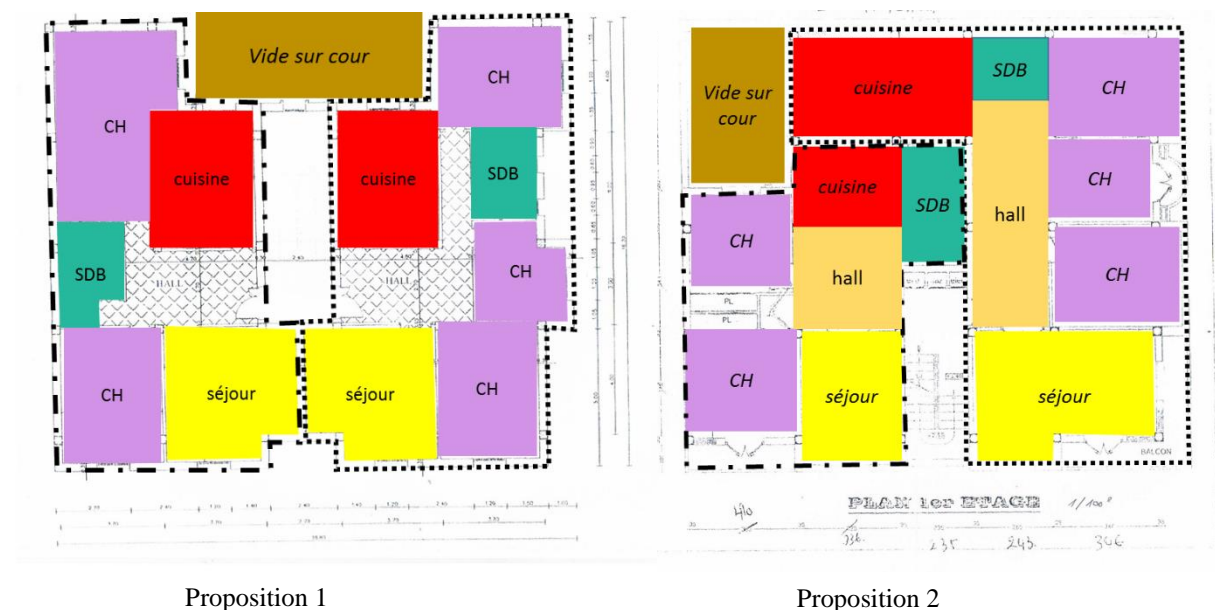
Différentes propositions de conception des logements, source : plans d'un cohabitant, traités par l'auteur.
